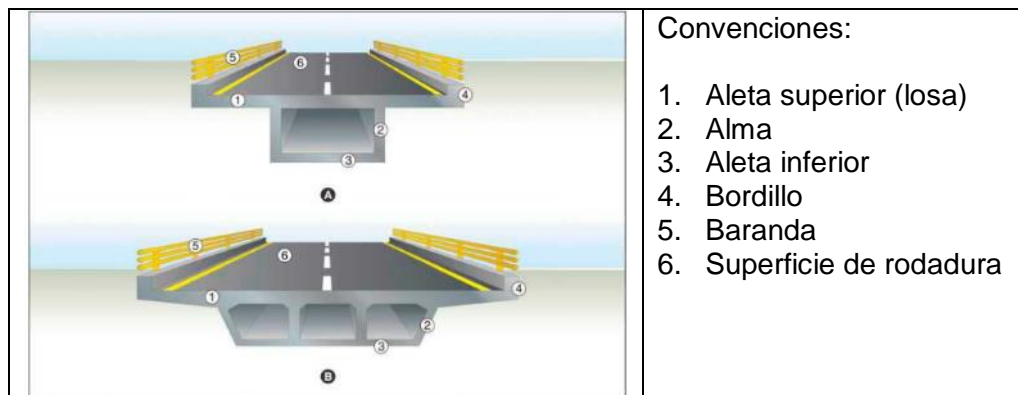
Tipología de vigas cajón. (A) Viga cajón de una sola celda de concreto reforzado o preesforzado. (B) Viga cajón de tres (3) celdas de concreto reforzado o preesforzado.
